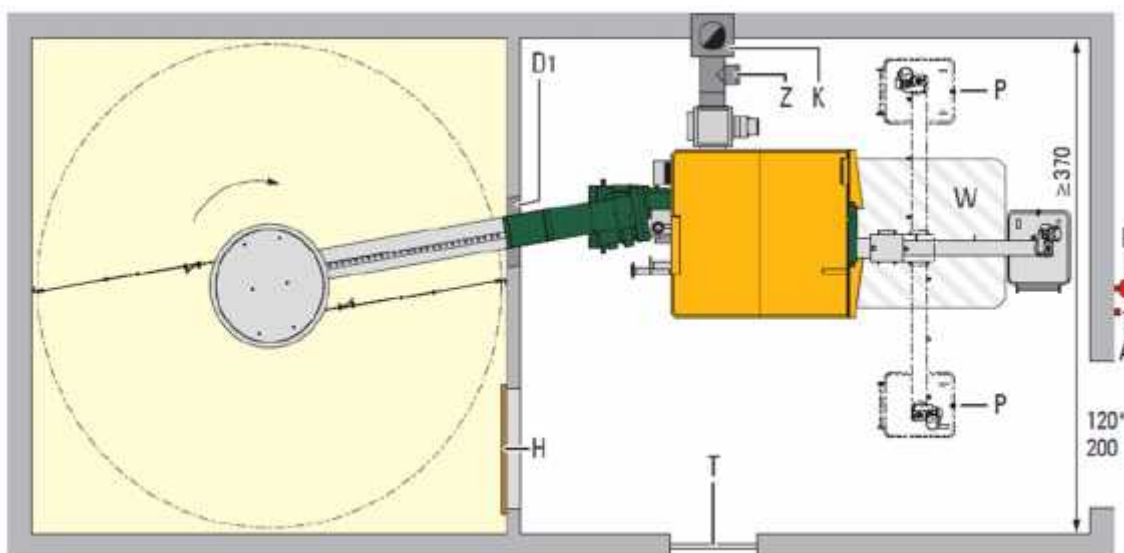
Vista de planta diseño sala de calderas propuesto por fabricante (KWB, 2018)
